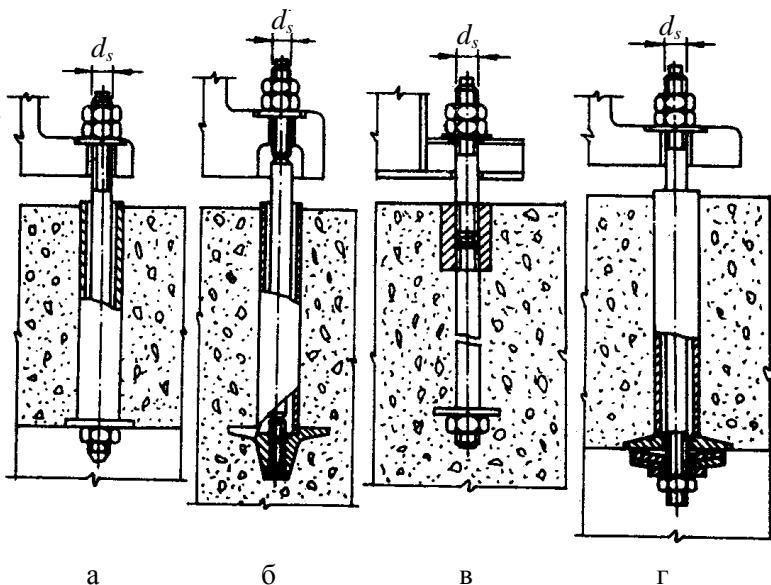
Анкерні болти, встановлювані до бетонування фундаментів:
